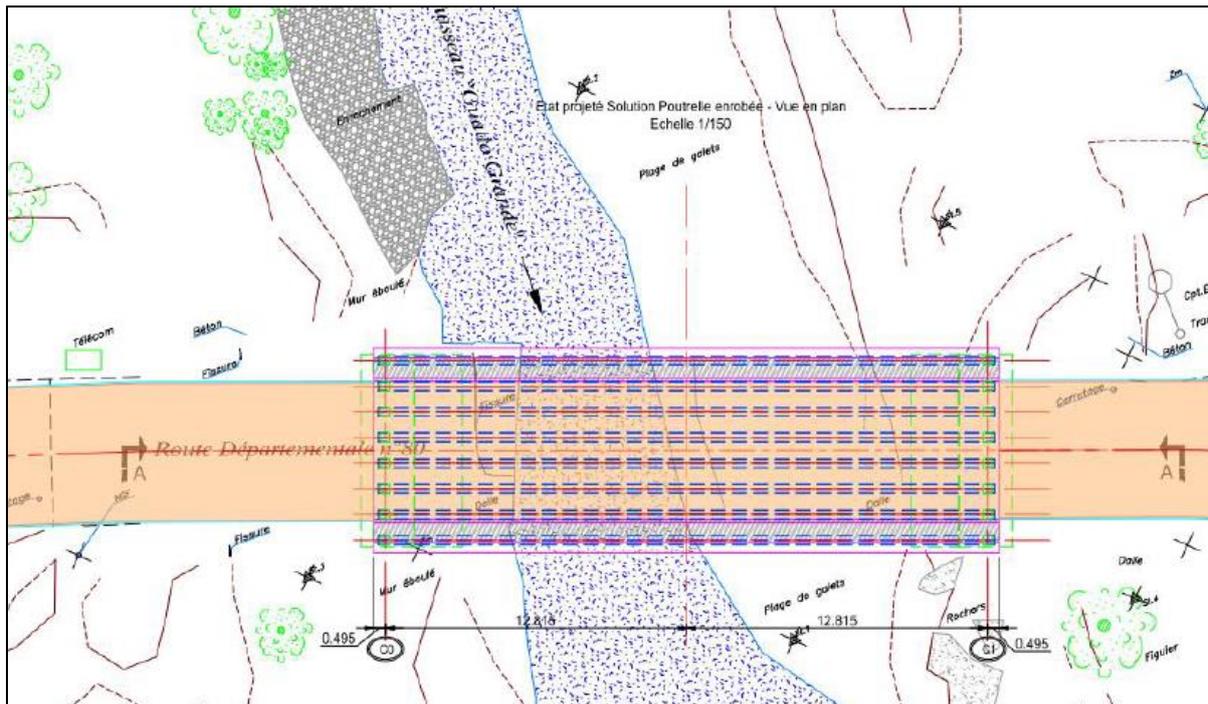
Etat projeté Solution Poutrelle enrobée – Vue en plan (source : Collectivité de Corse)
